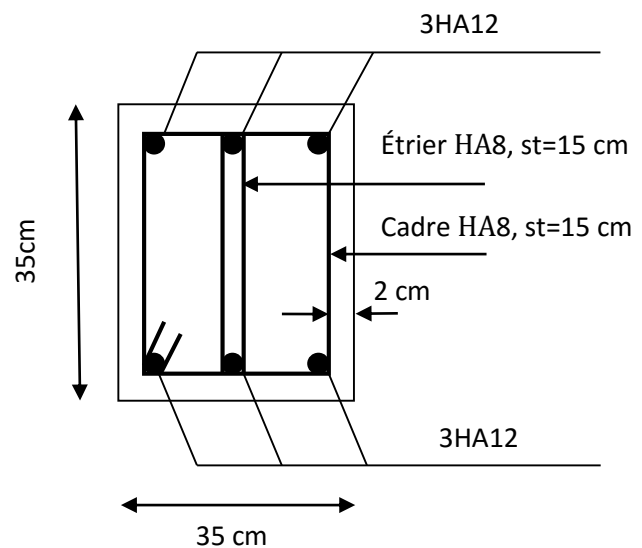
Schéma de ferrailage en appui de la poutre palière.
